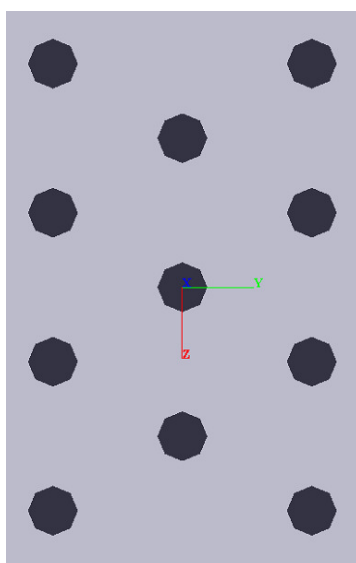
Vista planimetrica del modello GROUPv2016.
